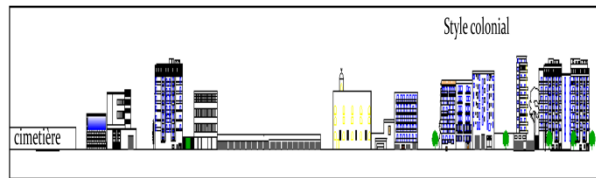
Façade sur le boulevard Med belouizded (sud)
